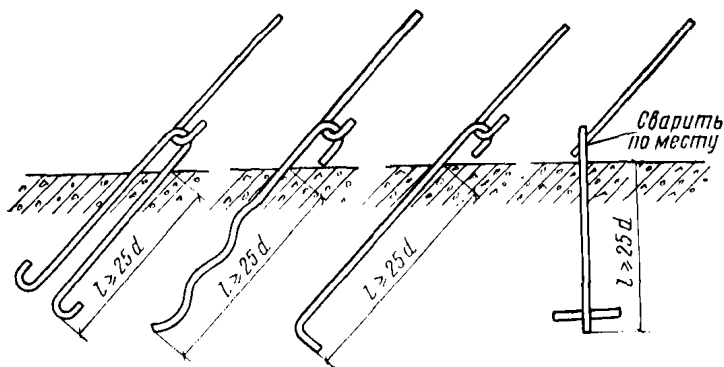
Различные типы анкеров, устанавливаемых при бетонировании массивных фундаментов для крепления опалубки
